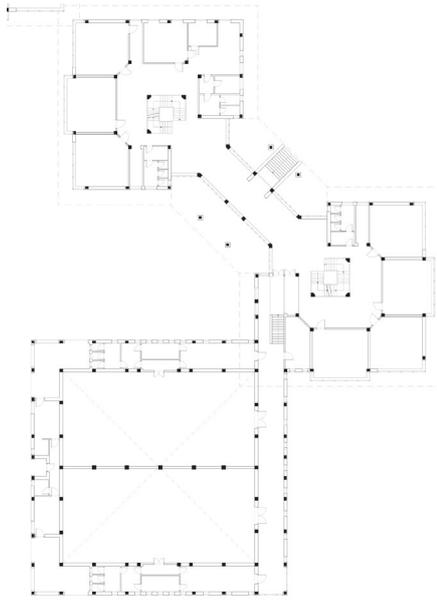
Pianta piano terra della terna sud. In evidenza, i pilastri strutturali dello scheletro portante.
